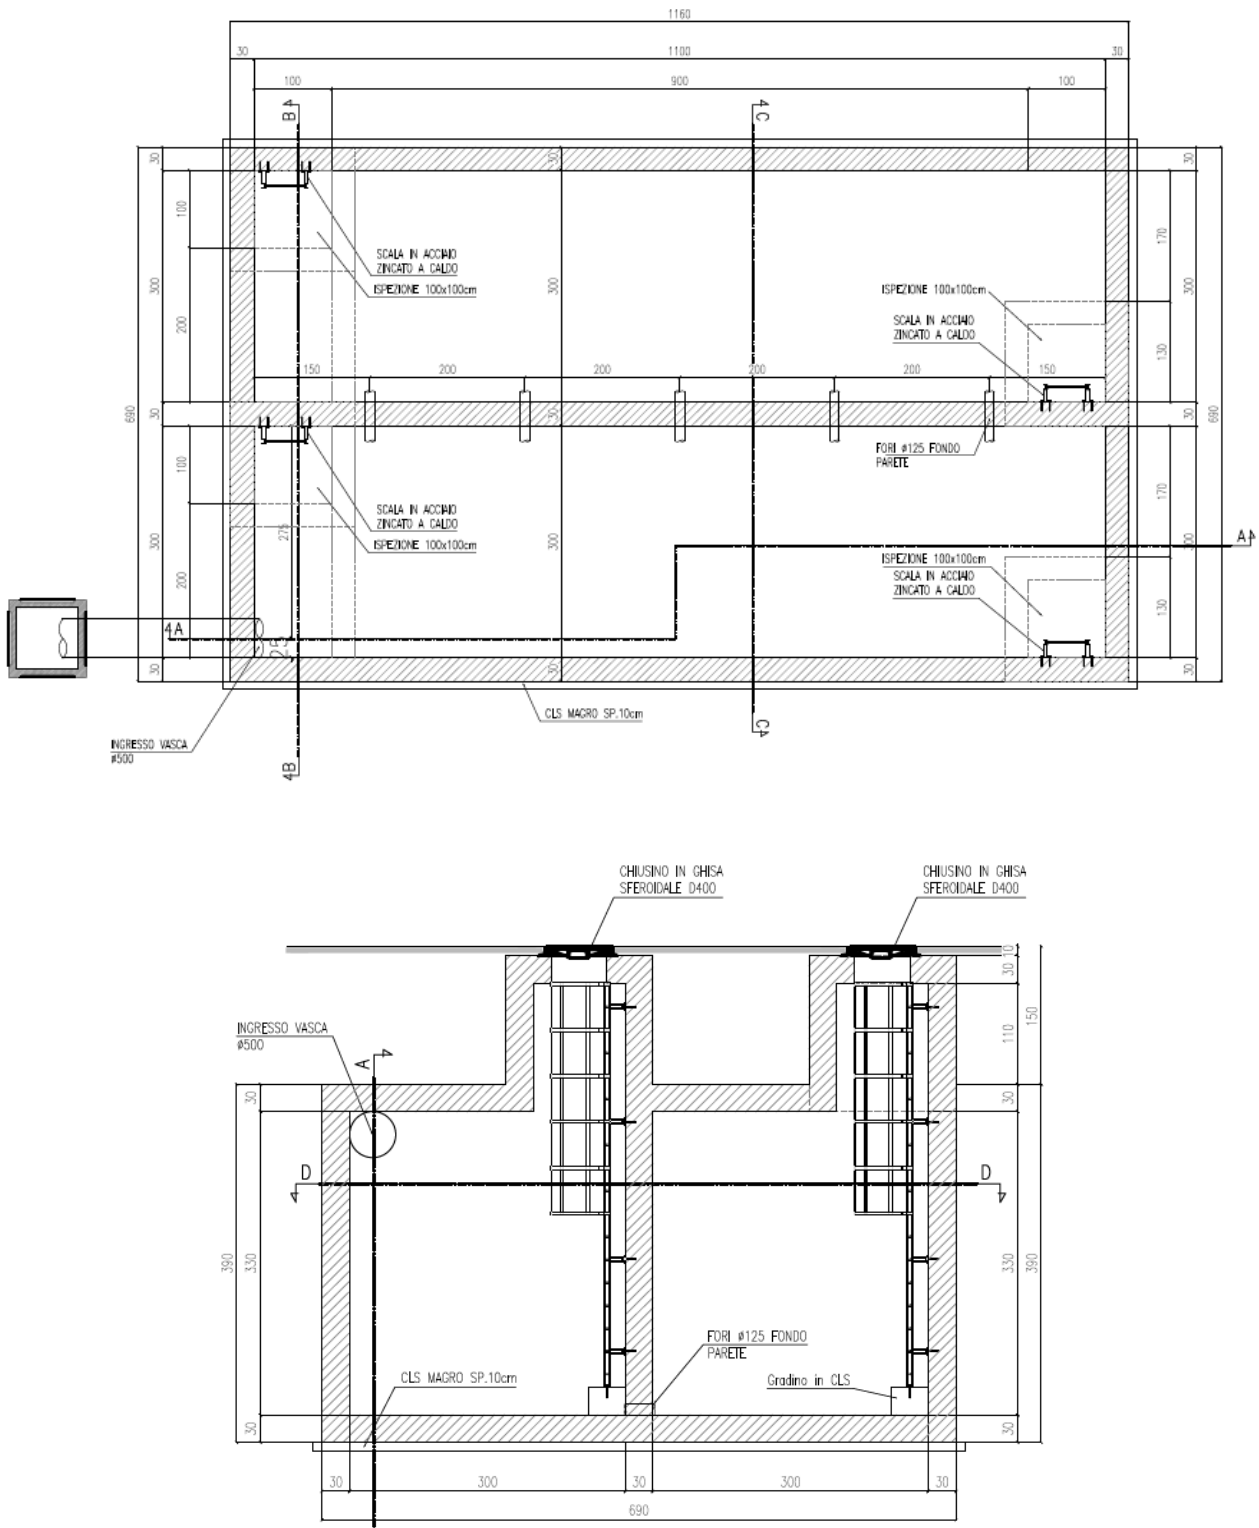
Pianta e sezione della vasca – Galleria Guinza
